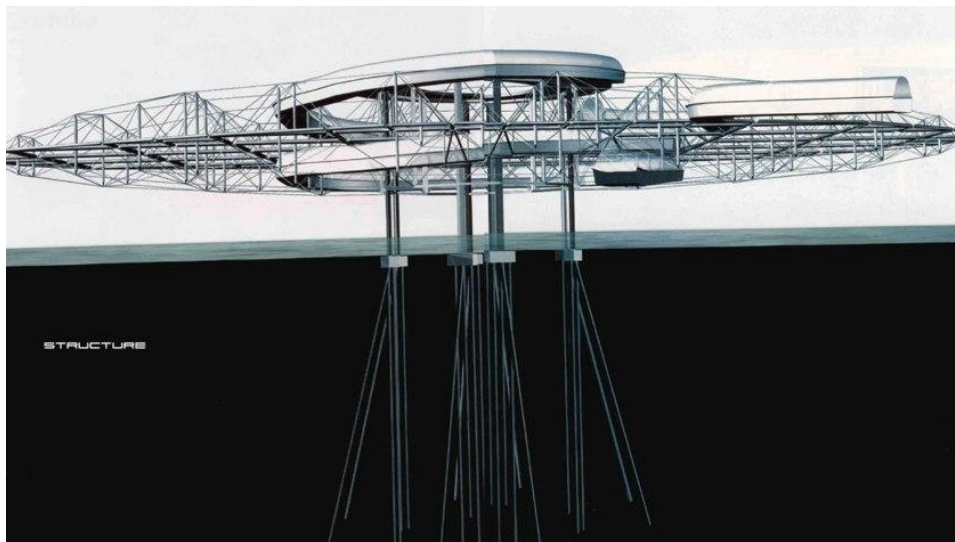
Sezione, “Blur Building”, Yverdon-les-Bains, Svizzera [2002]
